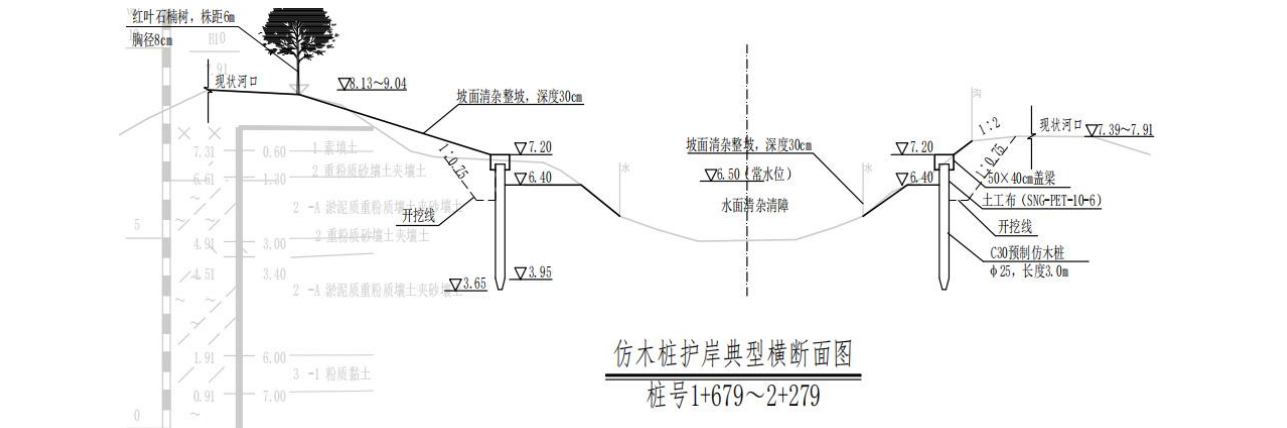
黄码七支大沟仿木桩护岸典型断面图
